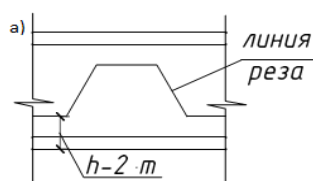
Балка с перфорированной стенкой: вид балки до разрезки
